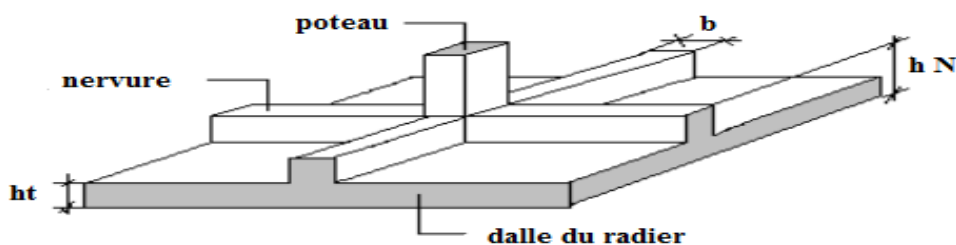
Disposition des nervures par rapport au radier et aux poteaux
